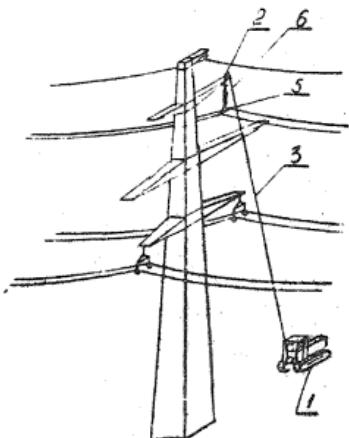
Перекладка проводов верхней траперсы с опусканием на среднюю траперсу опоры.
